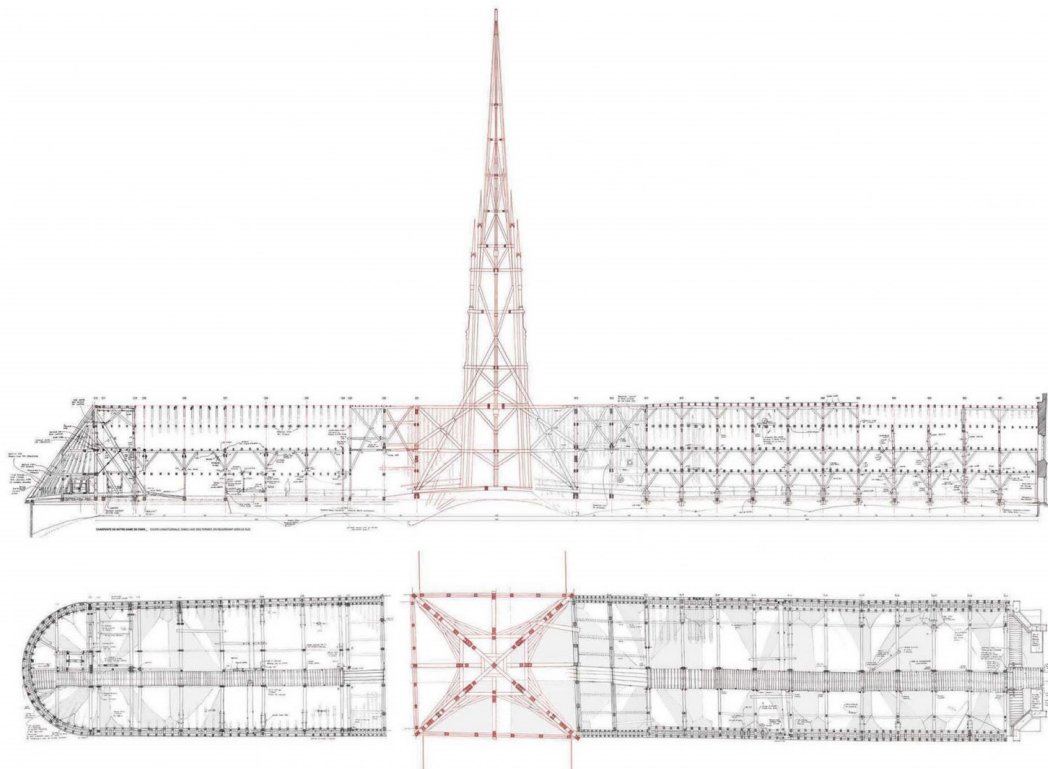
Sección y planta de la cubierta de Notre-Dame
